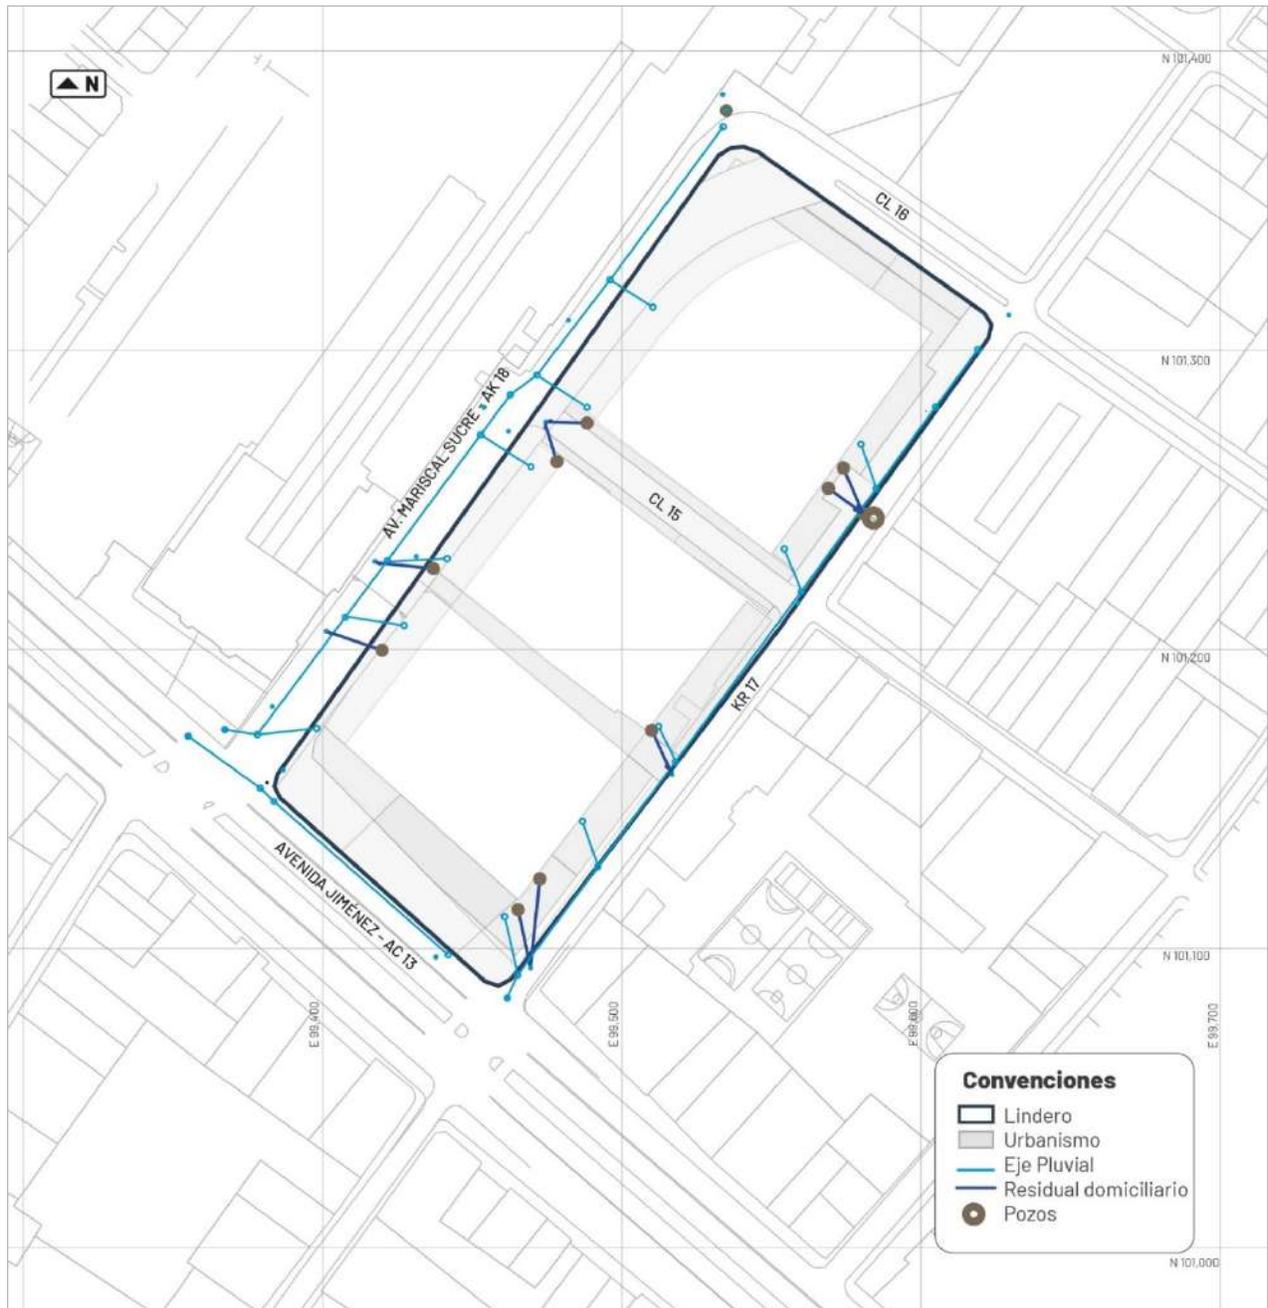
Planta General de Drenaje - Alcantarillado Sanitario
